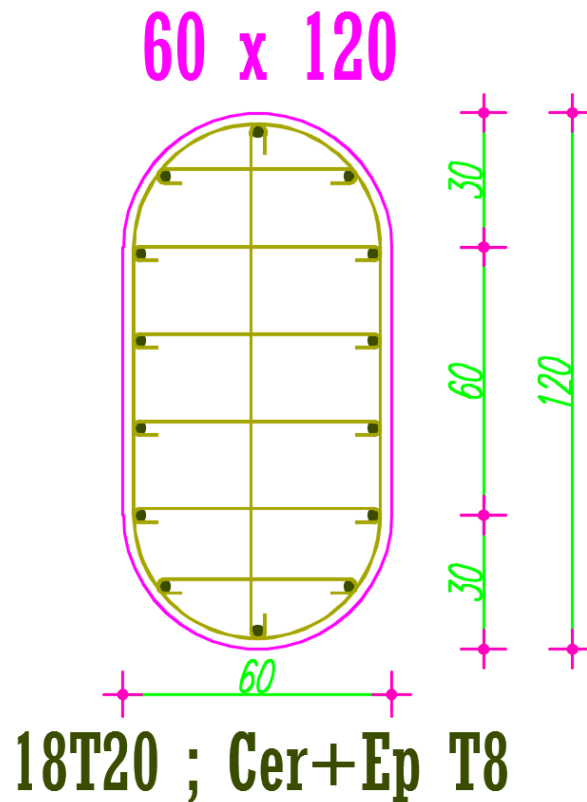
Ferraillage des poteaux P60 et P61 au sous-sol 2
